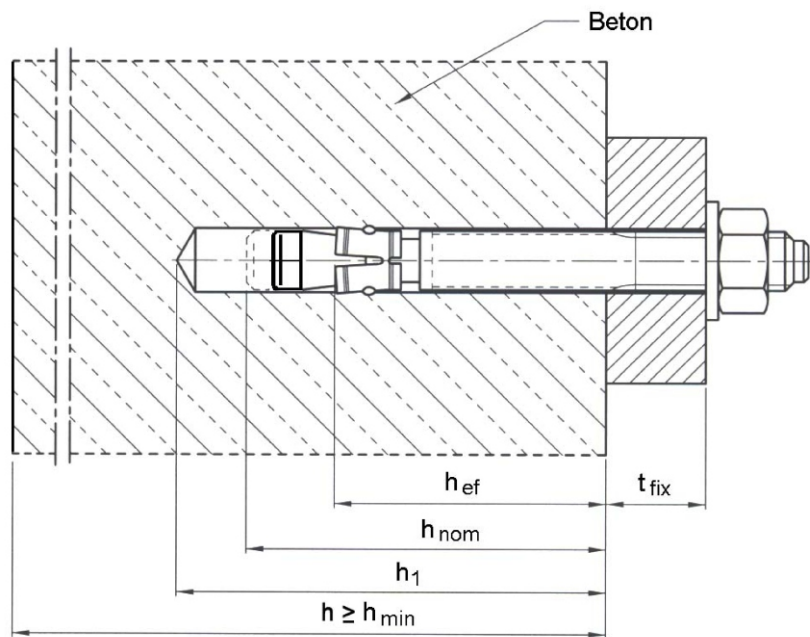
Schemat zakotwienia urządzenia do powierzchni betonowej
